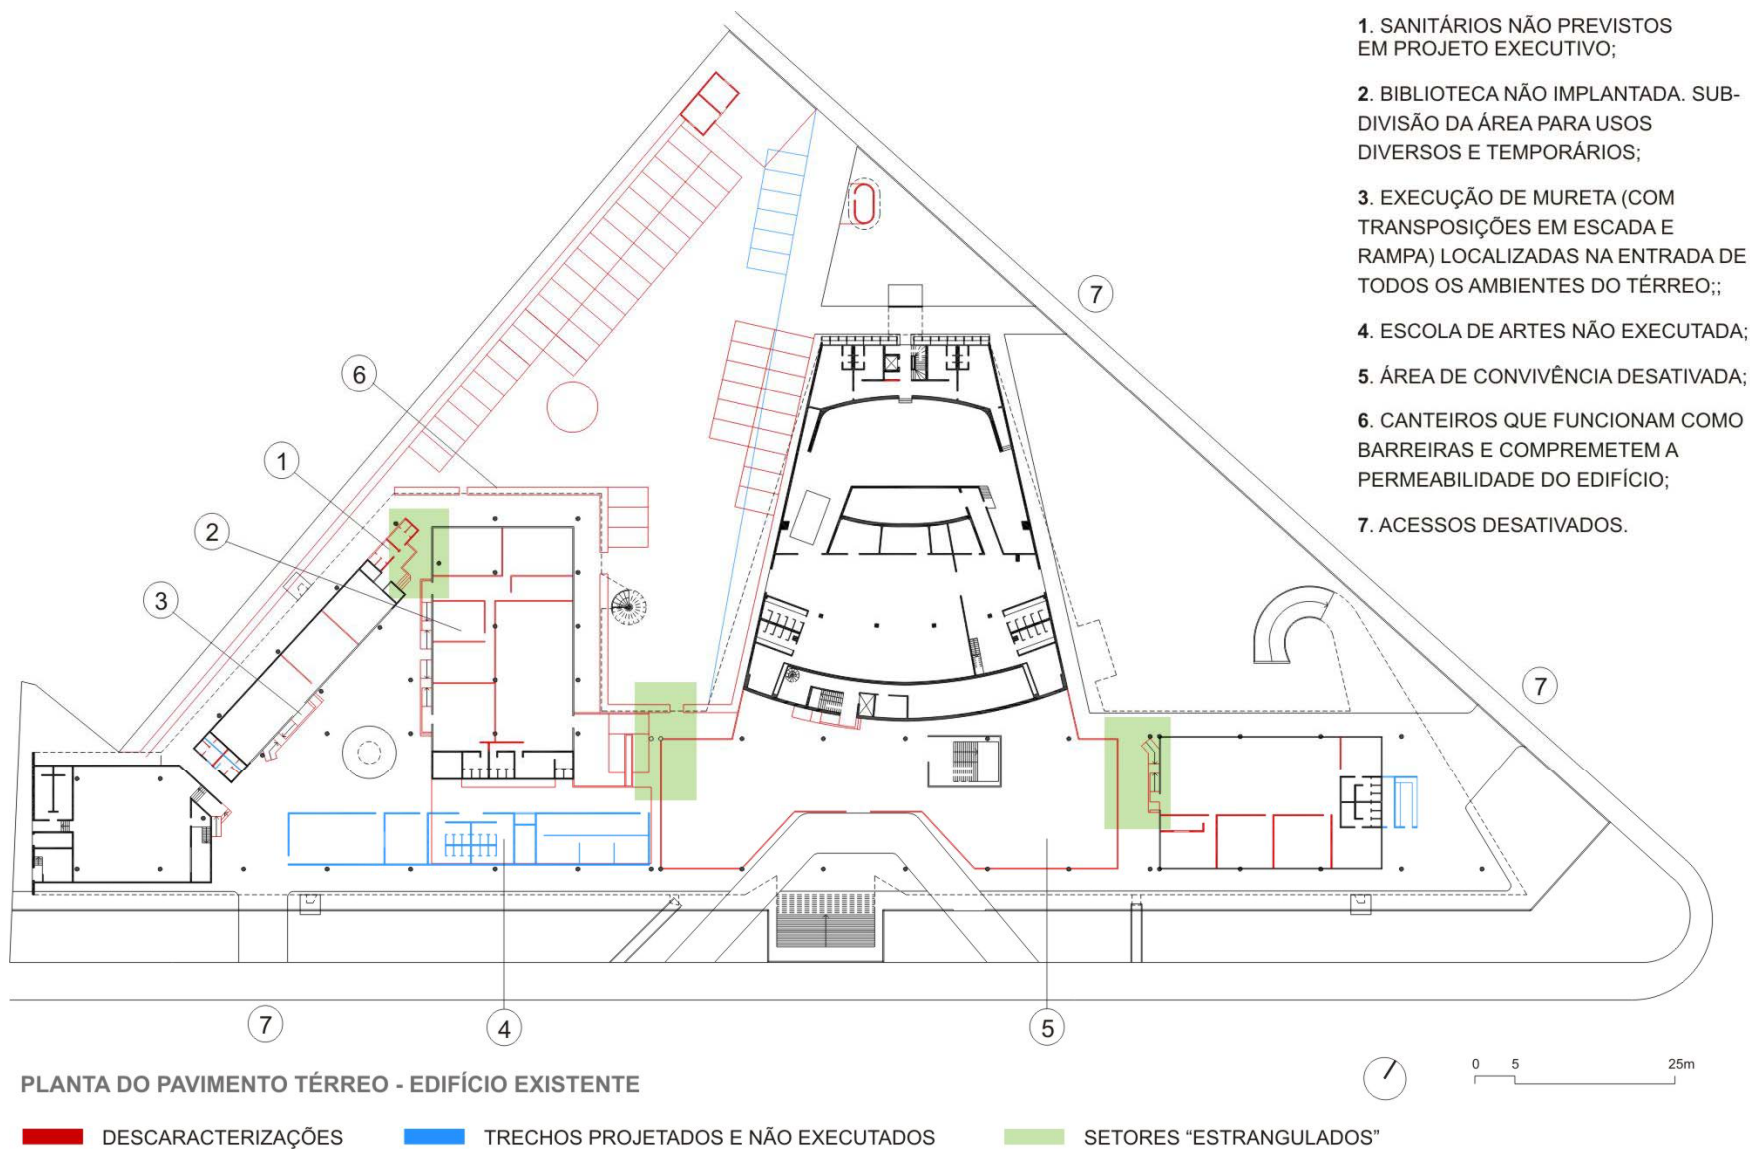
Planta do pavimento térreo do edifício existente. As descaracterizações mais significativas se concentram no pavimento térreo. Nota-se, em verde, as áreas que estão "estranguladas" devido às alterações sem critério. Desenho elaborado pelo autor.
